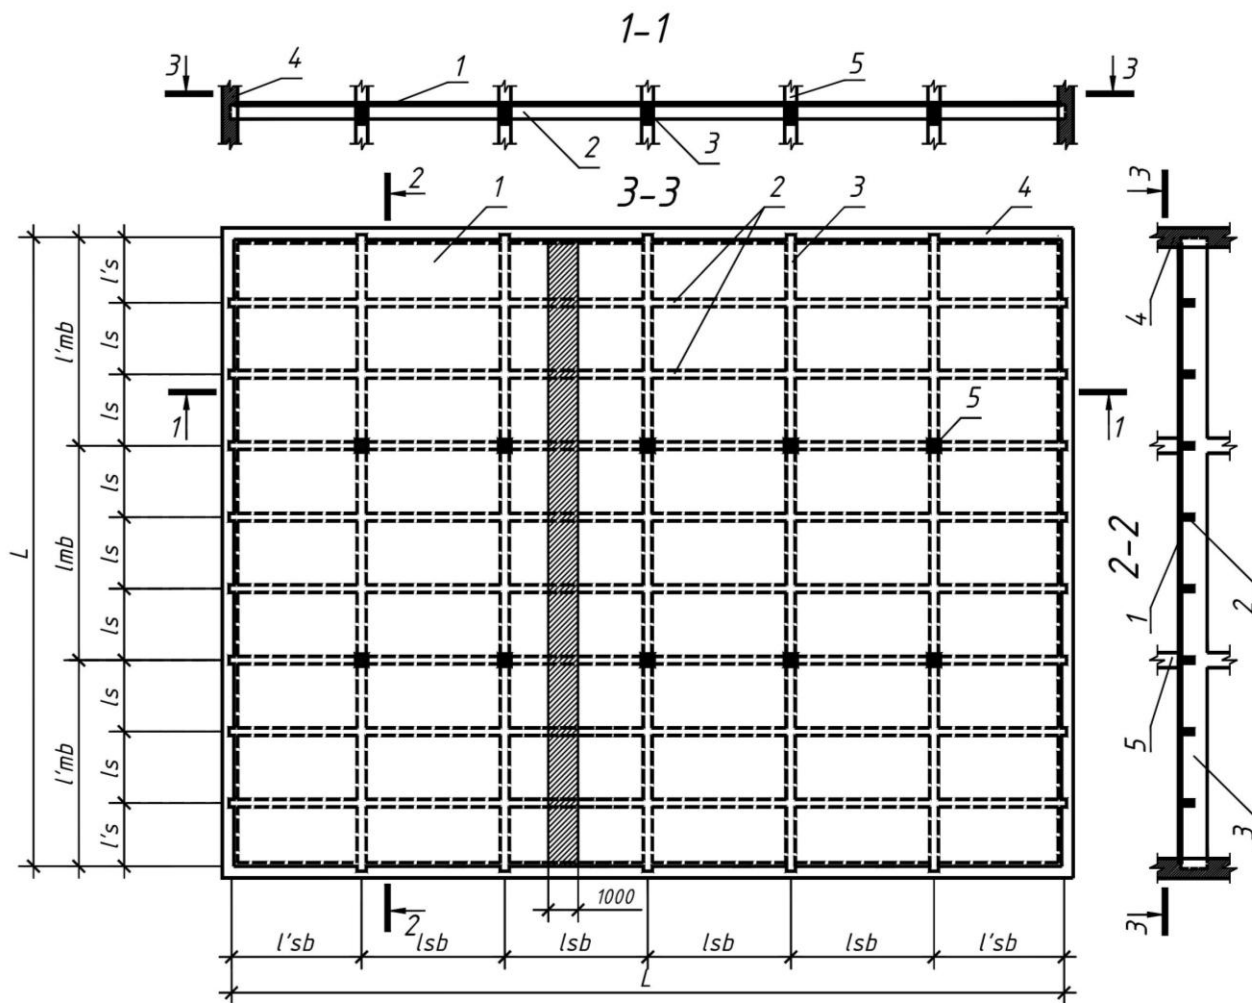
План монолітного ребристого перекриття з головними балками впоперек будівлі: 1 – плита; 2 – другорядна балка; 3 – головна балка; 4 – стіна; 5 – колона
